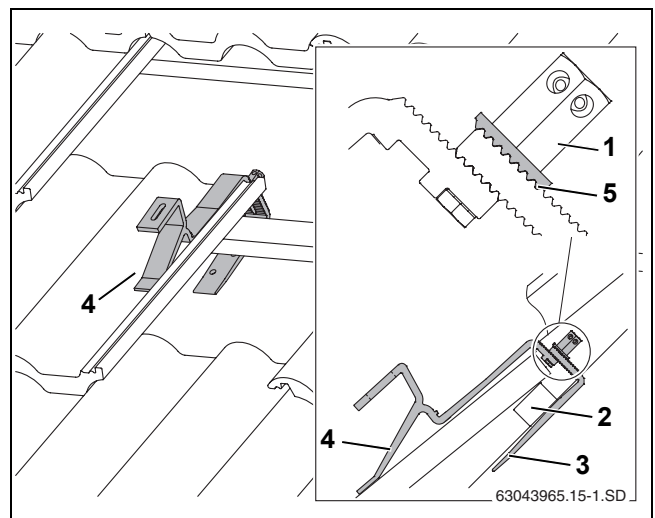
Gancho de tejado enganchado (para facilitar la vista se han eliminado de la figura algunas tejas)
